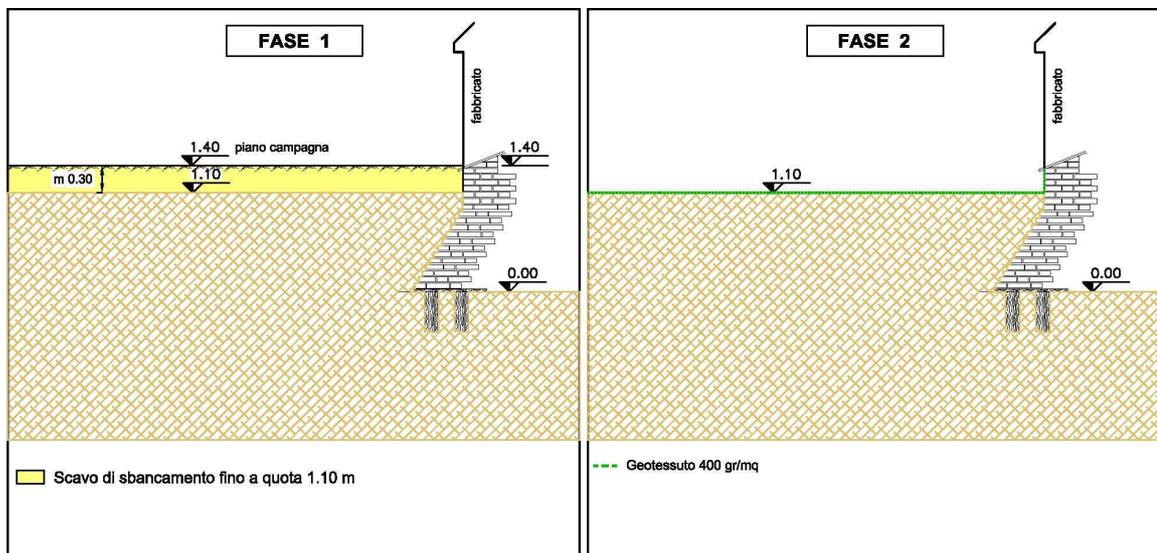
Fasi di intervento e sezione tipo di ripristino altimetrico del terzo lotto
